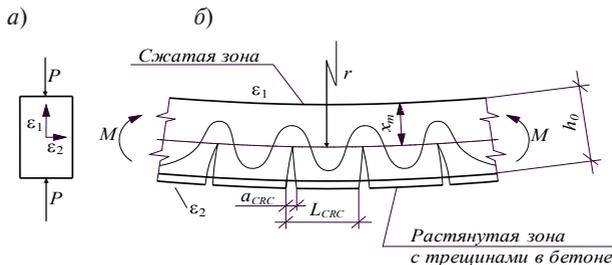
Деформации элементов при сжатии (а) и изгибе (б): ϵ_1, ϵ_2 – деформации сжатия и растяжения; r – радиус кривизны; a_{crc} – ширина раскрытия трещины; L_{crc} – расстояние между трещинами; x_m – средняя высота сжатой зоны бетона
